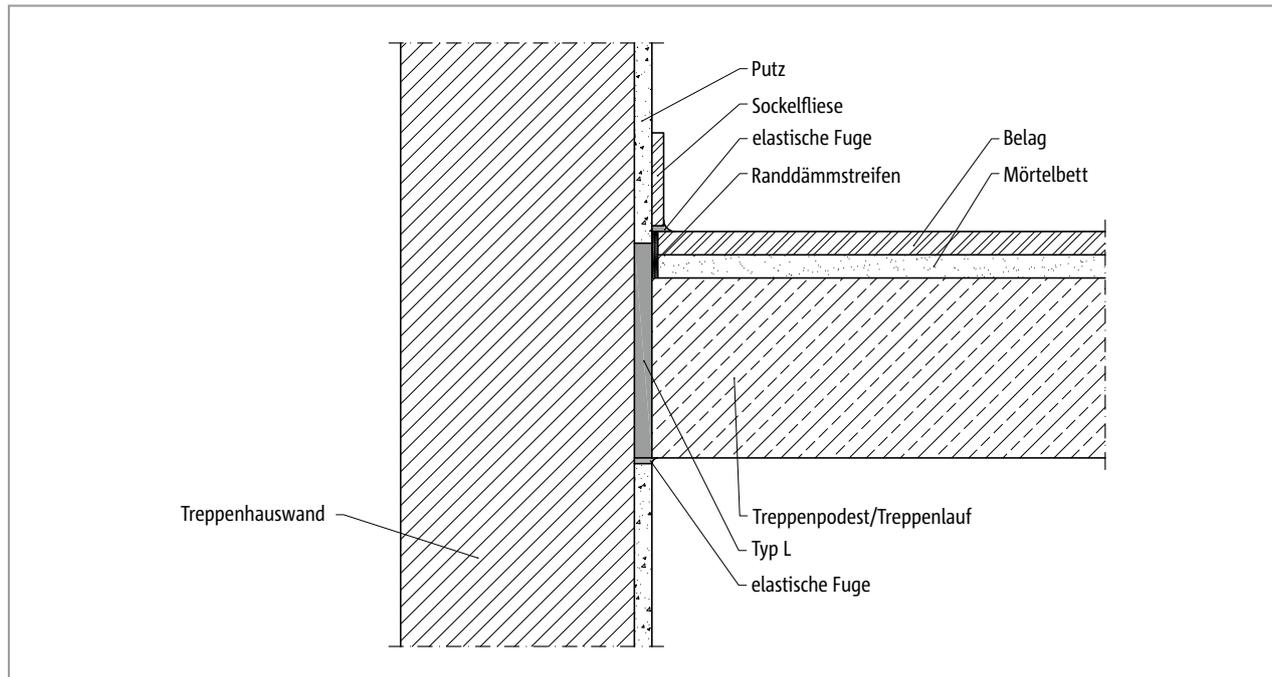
Schöck Tronsole® Typ L: Einbauschritt Ortbetontreppe
